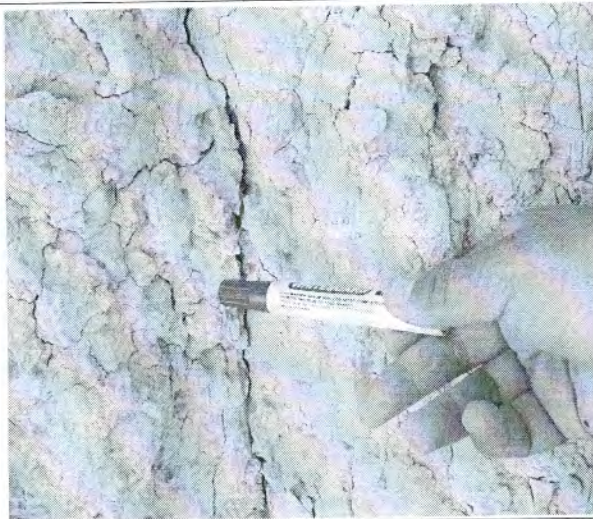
des fissuration dans les calcaires et Torba du talu hamadien
